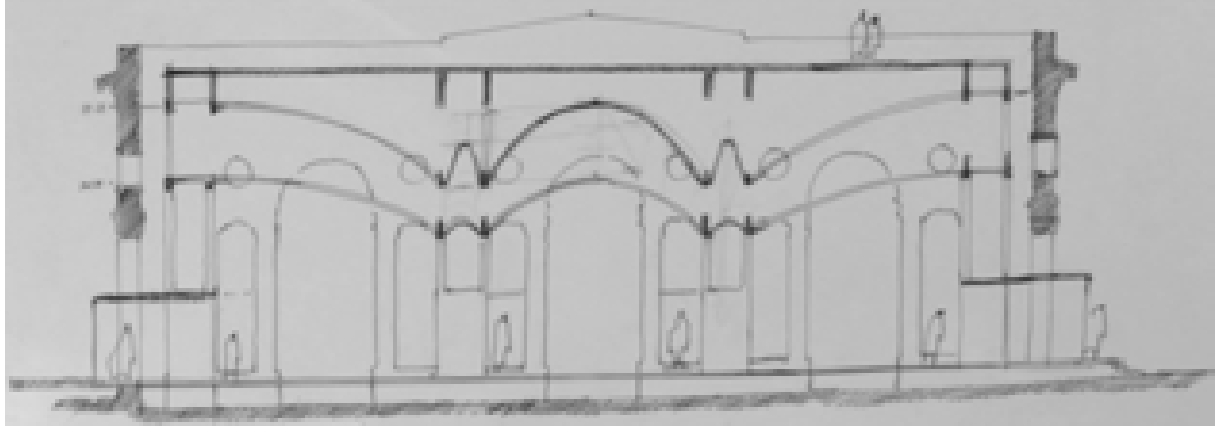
Ipotesi di sezione longitudinale (AABS-951)
